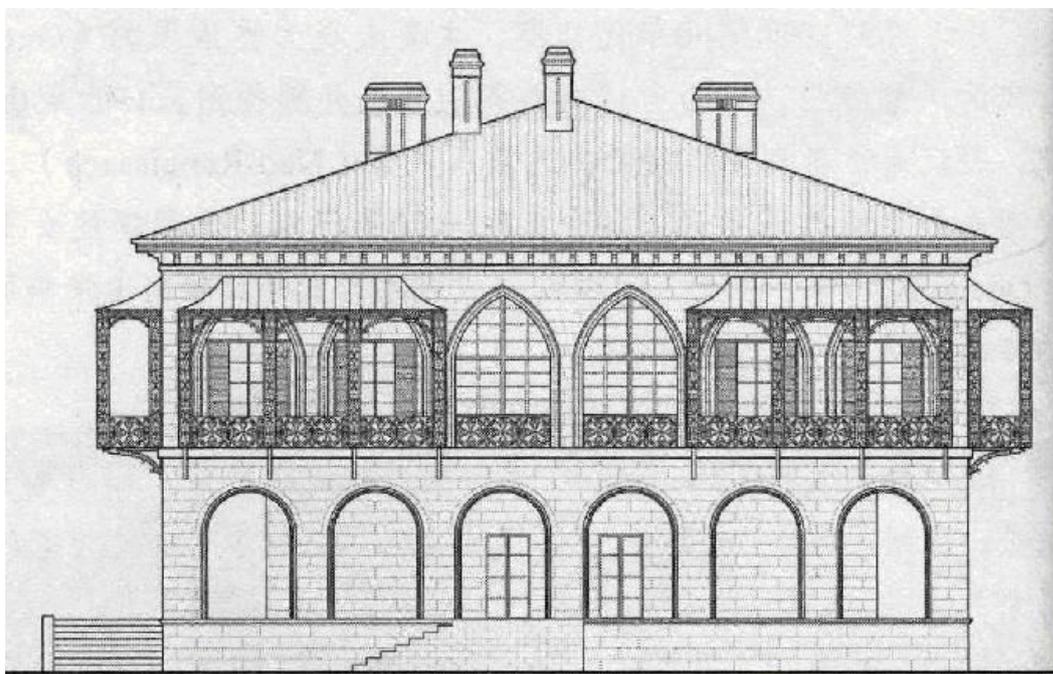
Dibujo de la fachada oriente del “Edificio Norte de Russell” en 1850s
